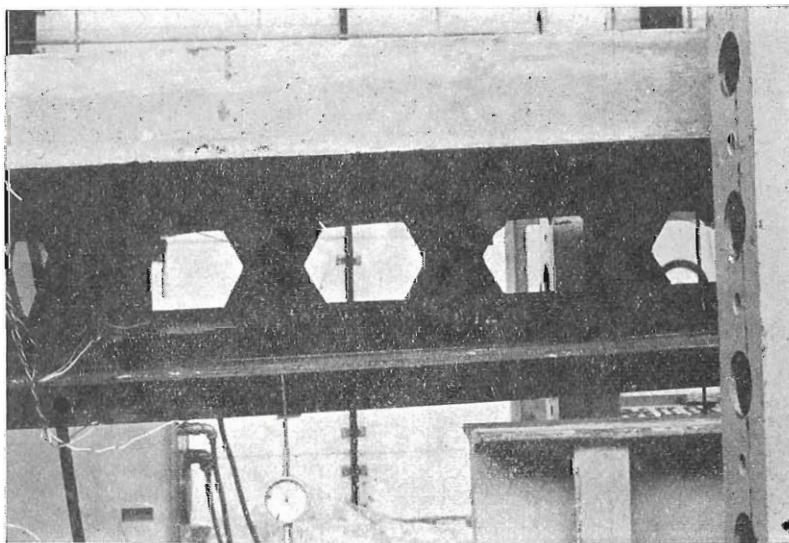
Detalle de fisura en sección metálica.
